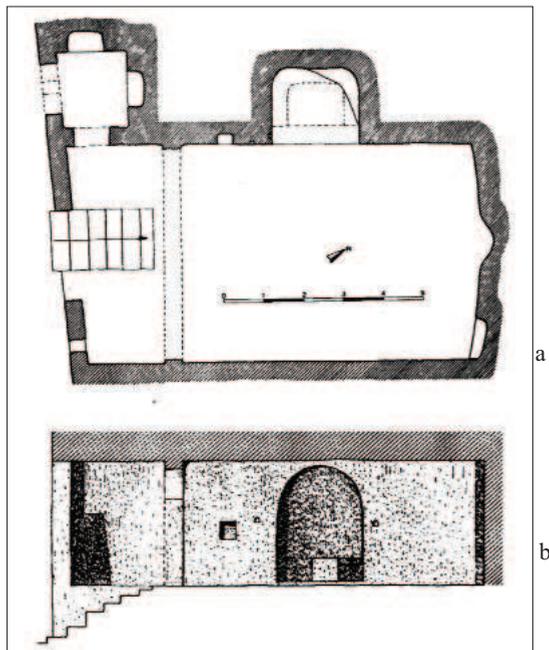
a - Cava Grande, Cansisini, chiesa rupestre. a) Planimetria; b) sezione longitudinale
